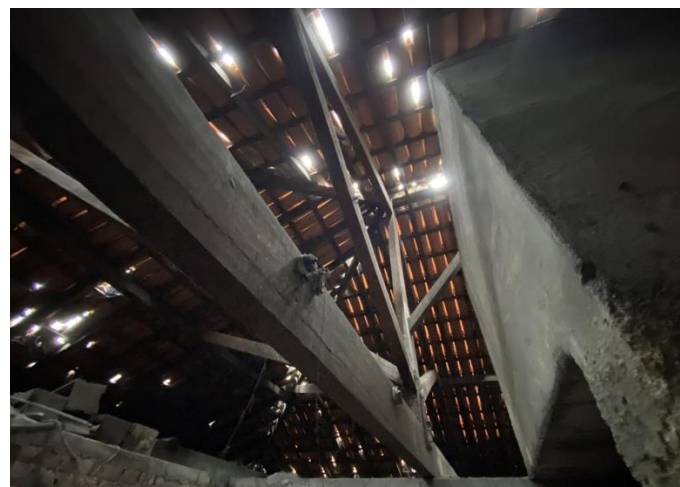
Outra vista, vendo-se uma caixa d'água em concreto.
